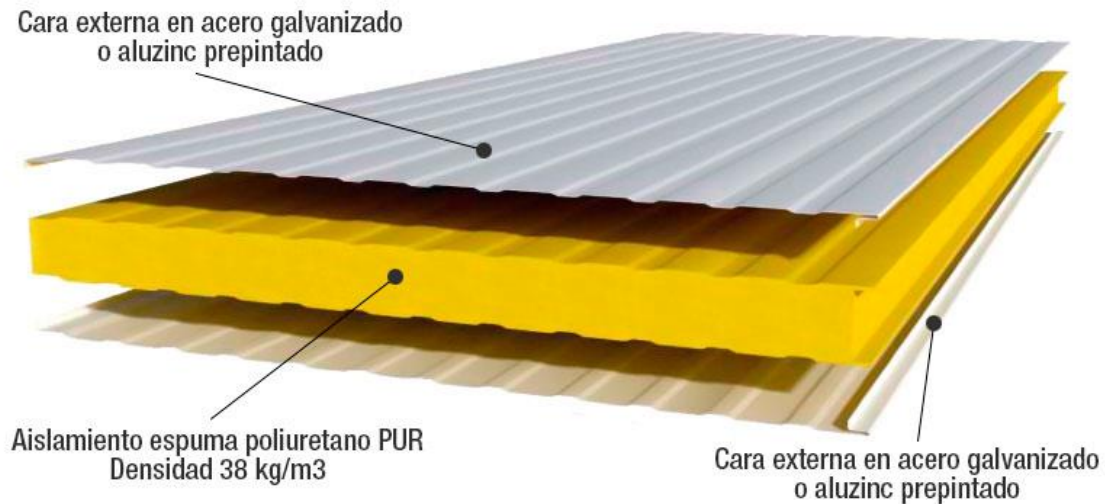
Detalle del panel sandwich. Fuente: Panelesandwich.com
